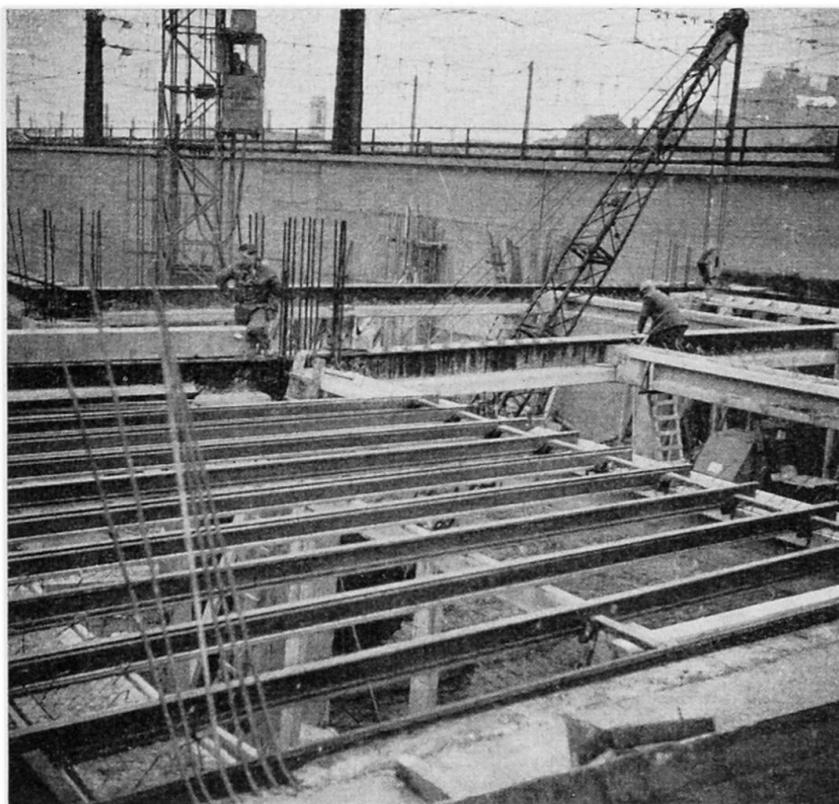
Gare d'Autobus de la Place Rogier à Bruxelles. Doubles cadres avec poutres Préflex de 16 m distants de 8,35 m. Les poutres secondaires sont préfabriquées en béton précontraint. Les nervures métalliques prennent appui sur les poutres secondaires et supportent les coffrages amovibles de la dalle coulée sur place.
